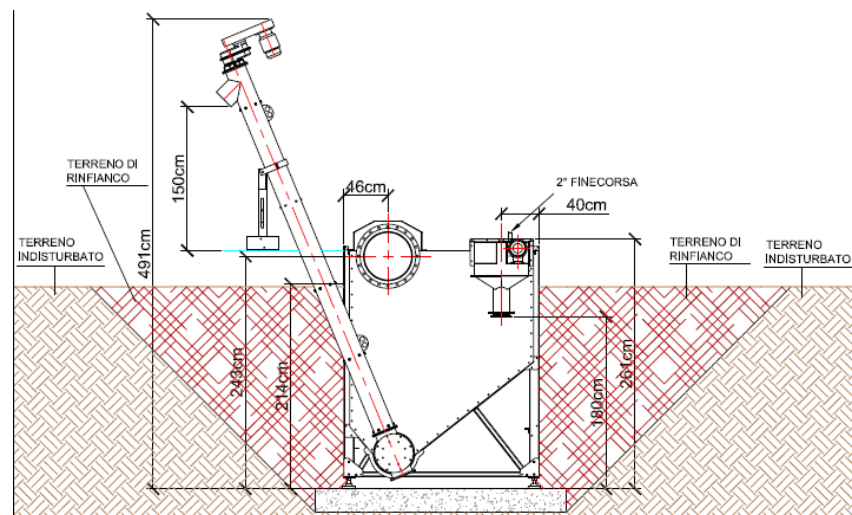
Soluzione di progetto approvato, sezione trasversale.
